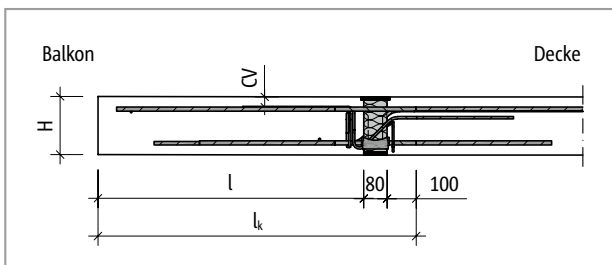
Schöck Isokorb® T Typ C: Statisches System
